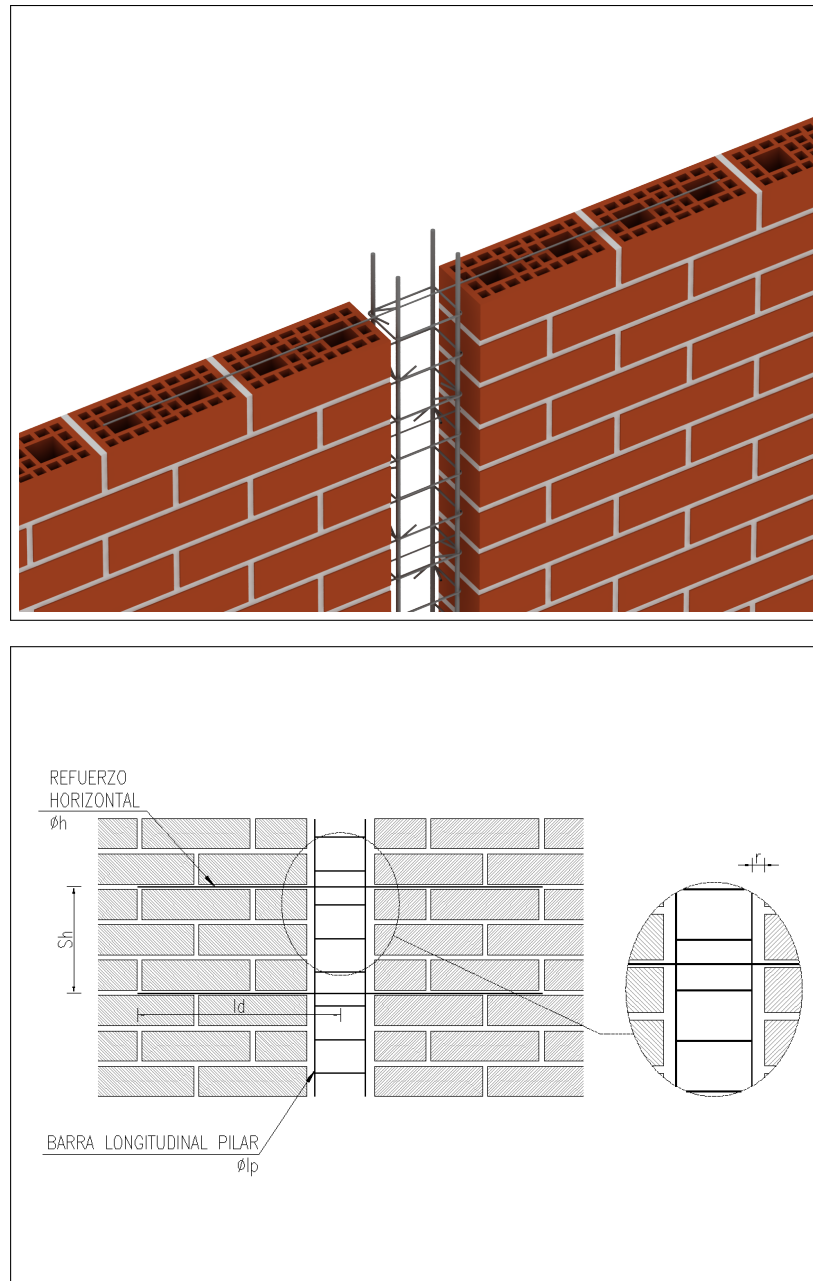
Detalle de la unión con conectores de acero entre el paño de albañilería y el pilar de confinamiento intermedio.
